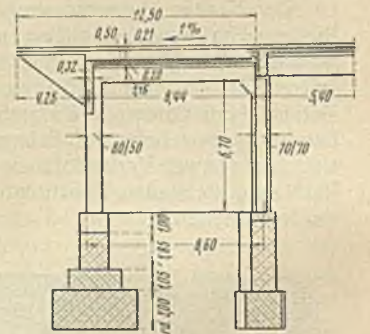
Hohlraumwiderlager. Grundriß und Längsschnitt.
